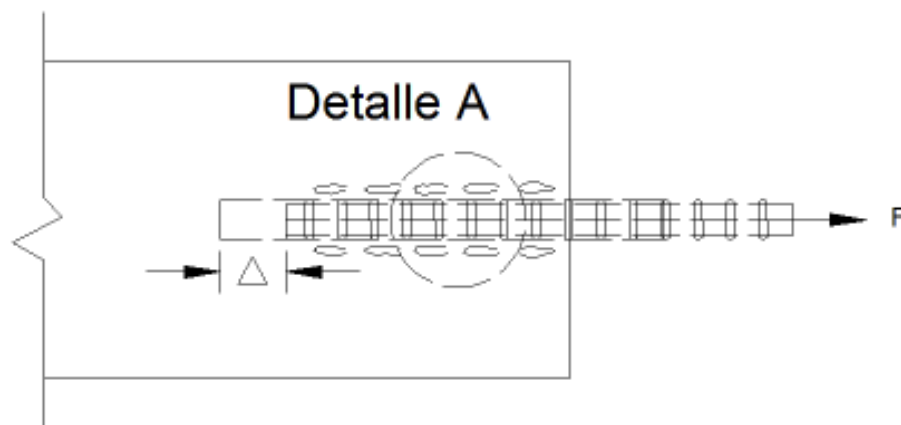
FALLA EXPLOSIVA POR SPLITTING DE LA ZONA A TRACCIÓN DE UNA VIGA, TERFERS (1973).
